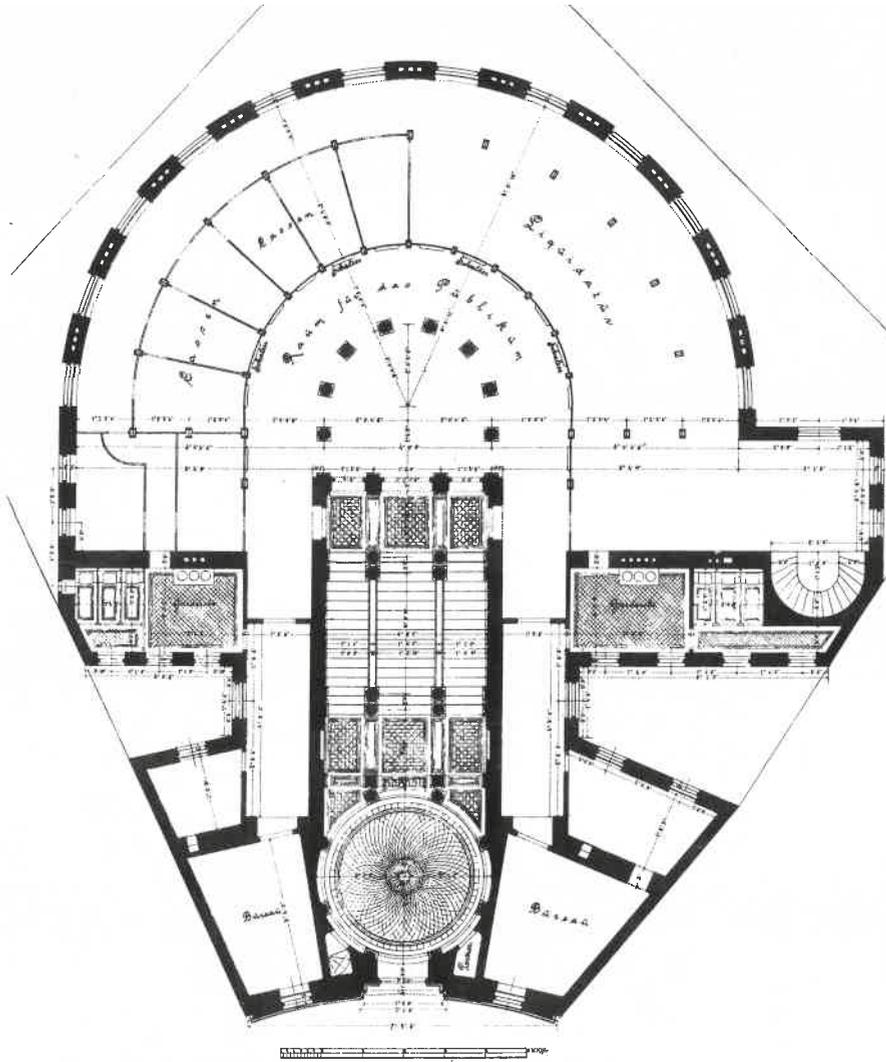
Amtsgebäude des Wiener Giro- und Cassenvereines, Grundriss-Entwurf, 1880 Rock-gasse Wien
